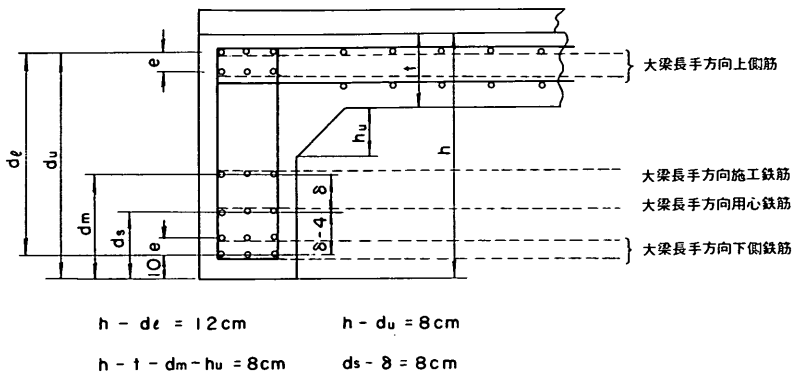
(2) 小ばり（短手方向ばり）の配筋
